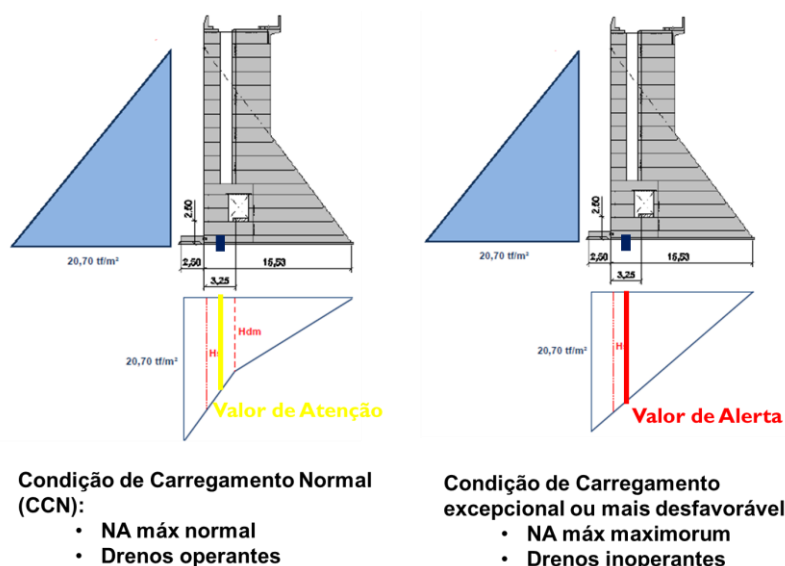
Valores de controle determinísticos para piezômetros instalados na fundação de estruturas de concreto.
